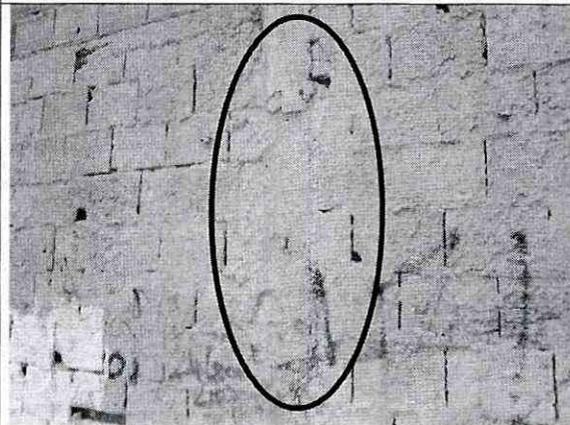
Fisuras entre bloques y en la junta con columnas.
